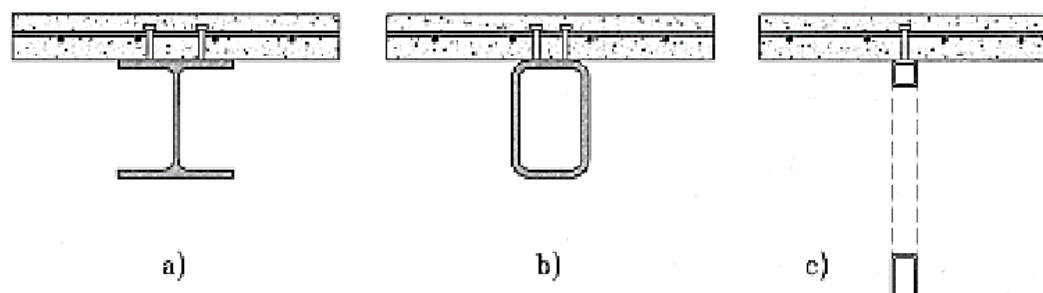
Aplicação de vigas mistas secções em I ou H (a), secção em caixão (b), sistema em treliça (c) (Vianna, 2009)
